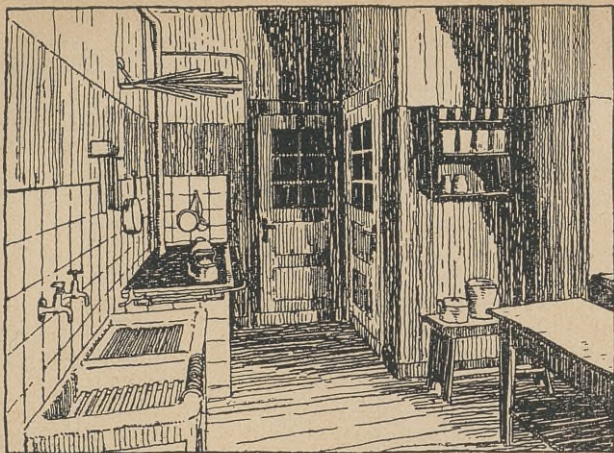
Kochküche mit Zentralheizungskessel, Gasherd, Spültisch mit warmem und kaltem Wasser in der Gartenstadt Steenkamp-Bahrenfeld. Architekt Neugebauer
